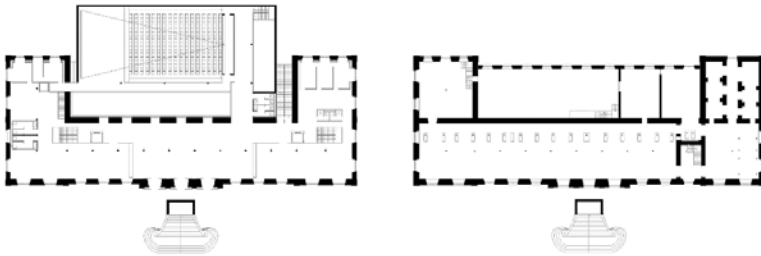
Planta baja. Edificio Reutilizado/Edificio Original.
